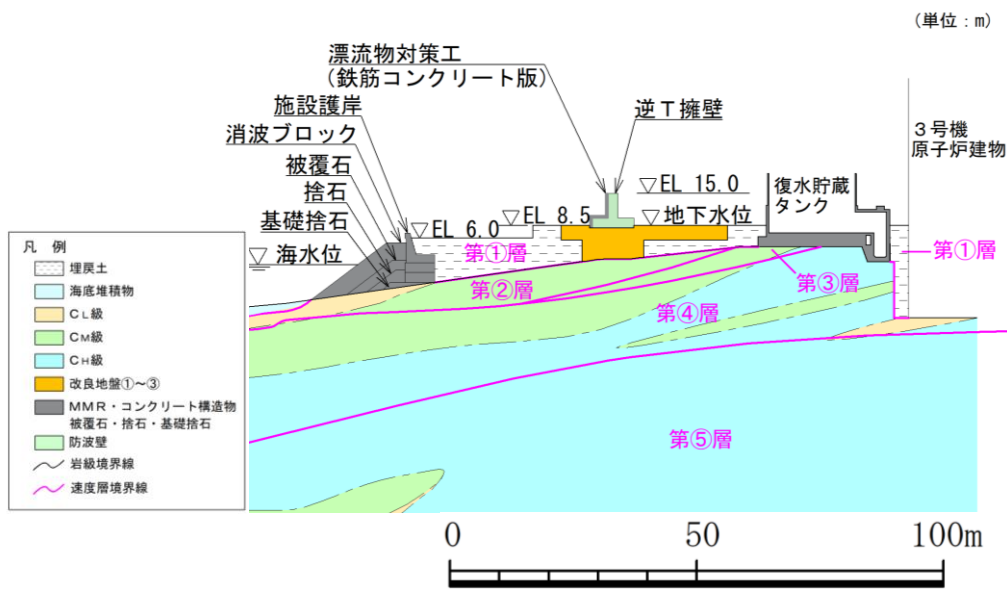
防波壁（逆T擁壁）の横断面図（③-③断面）
